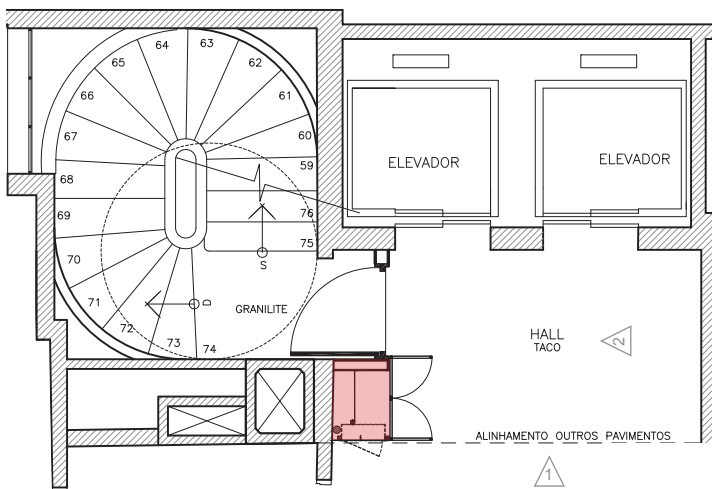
Planta - Instalação das novas prumadas - 1:100
